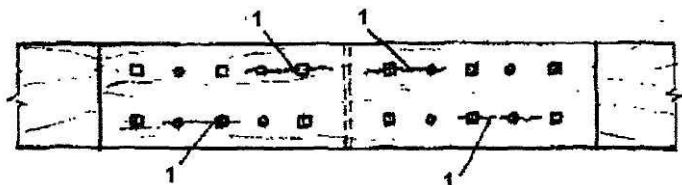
Схема трещин у нагелей в растянутом стыке деревянных элементов, свидетельствующих об опасности разрушения стыка:
